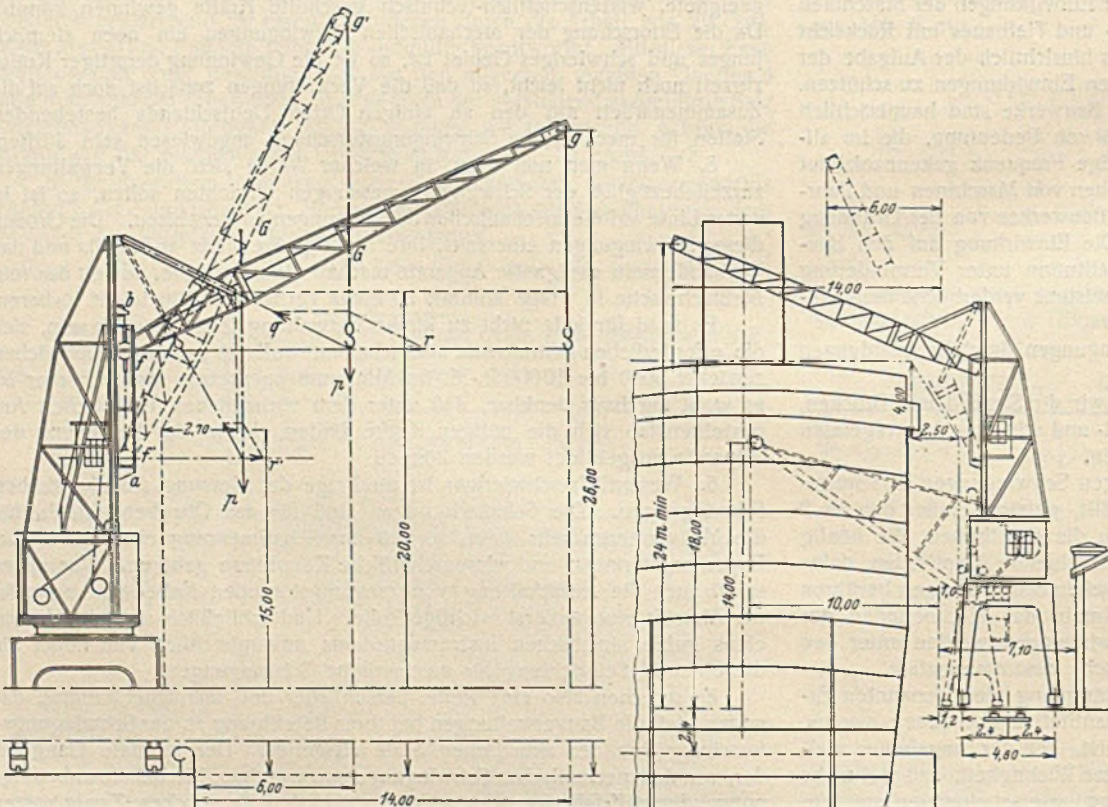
Schema der geplanten Portaldrehkrane mit heb- und senkbarem Ausleger für den Wilson-Hafen.
